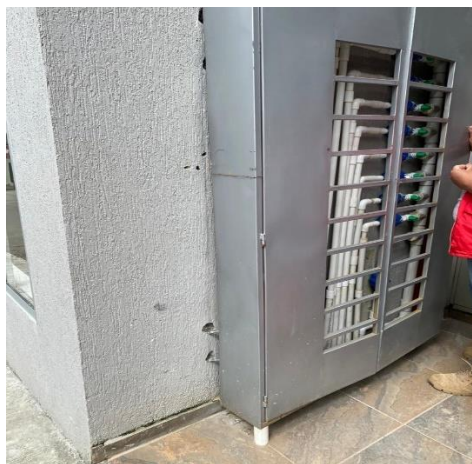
Mueble metálico para contador visiblemente sin soporte de pared.
